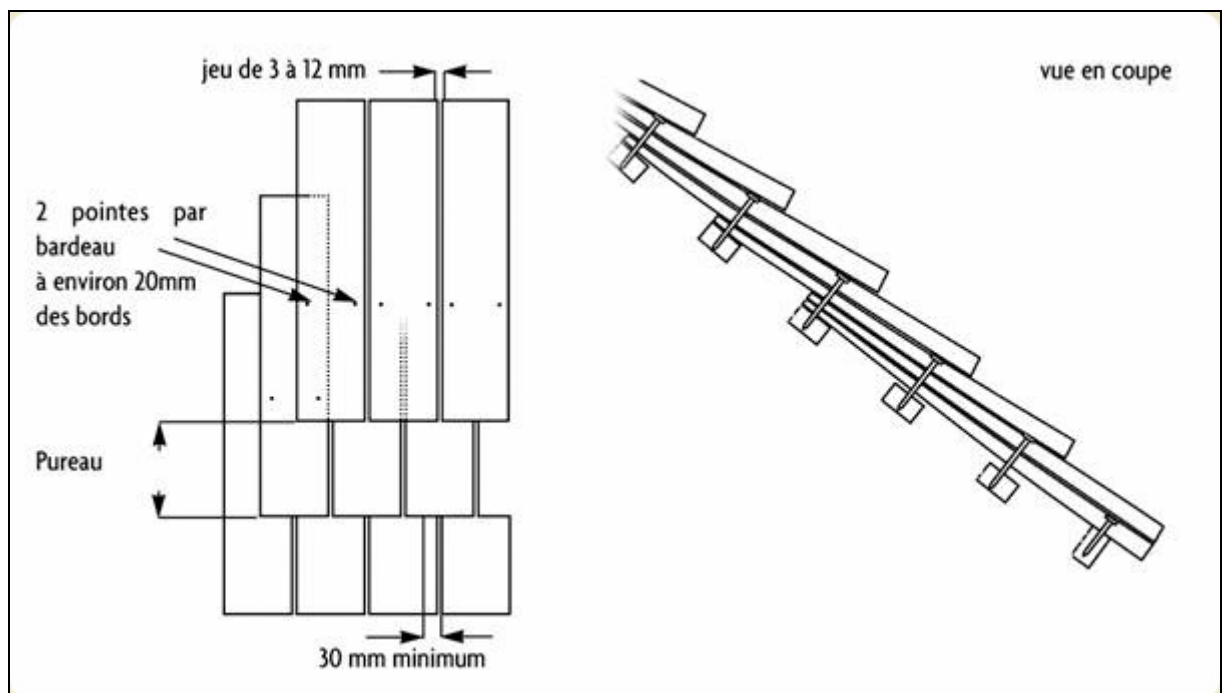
Schéma de disposition des bardeaux (source : La Tuile de Bois SOVECO)
